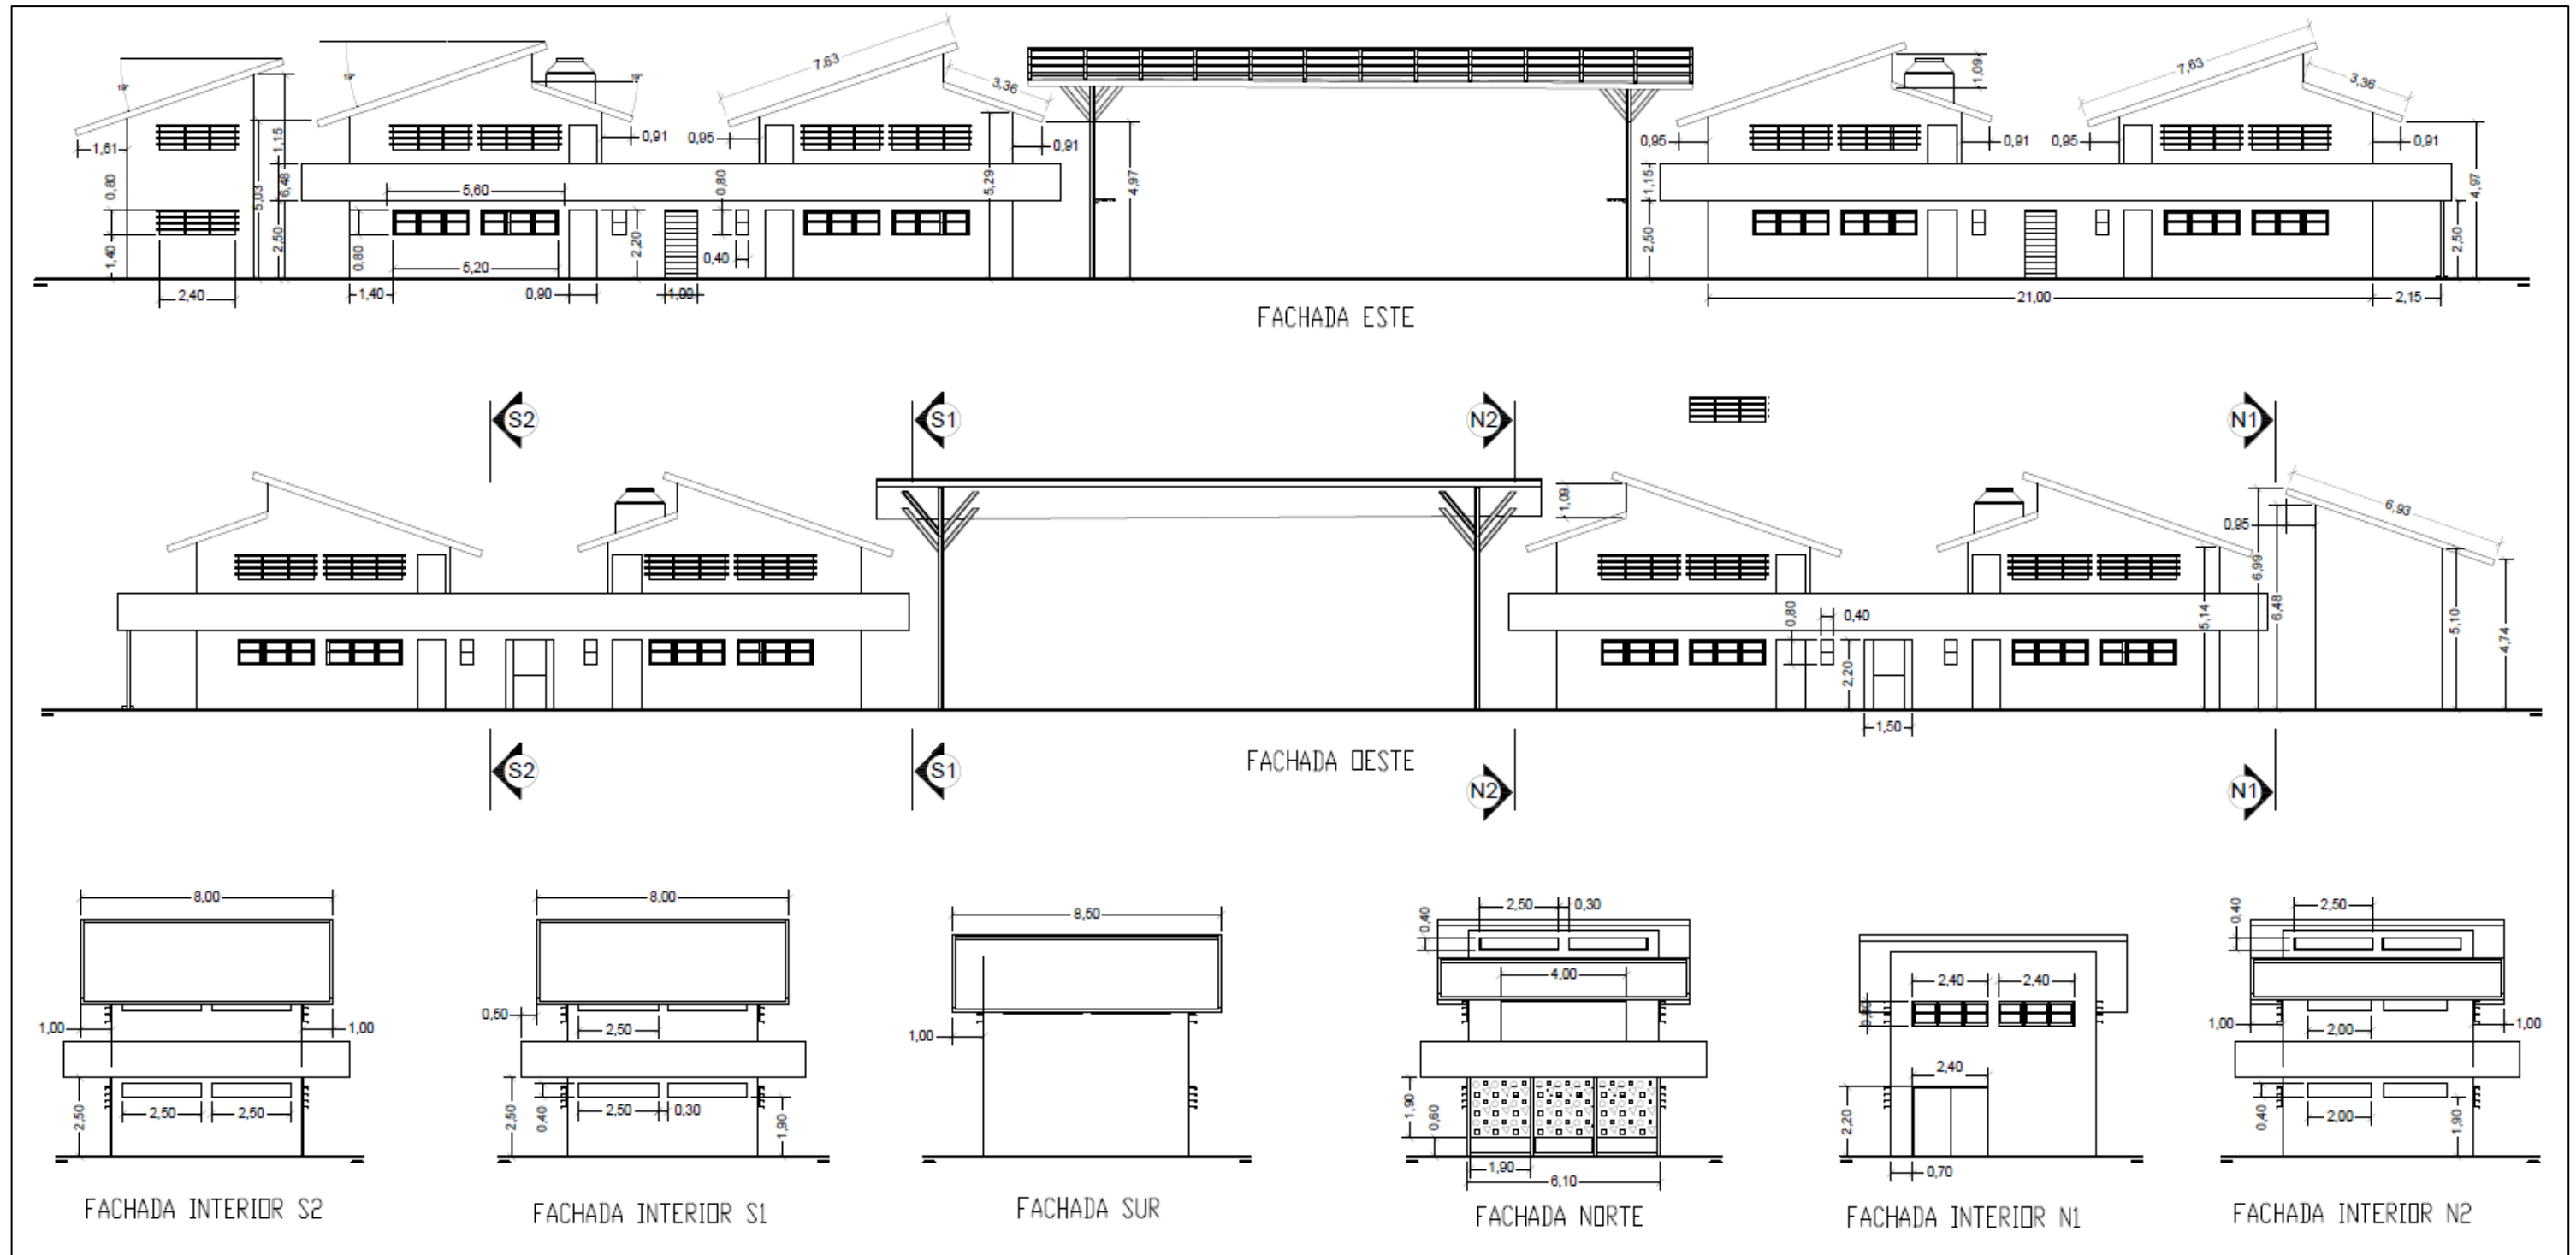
Plano-Fachadas arquitectónicas. Fuente: Elaboración propia
